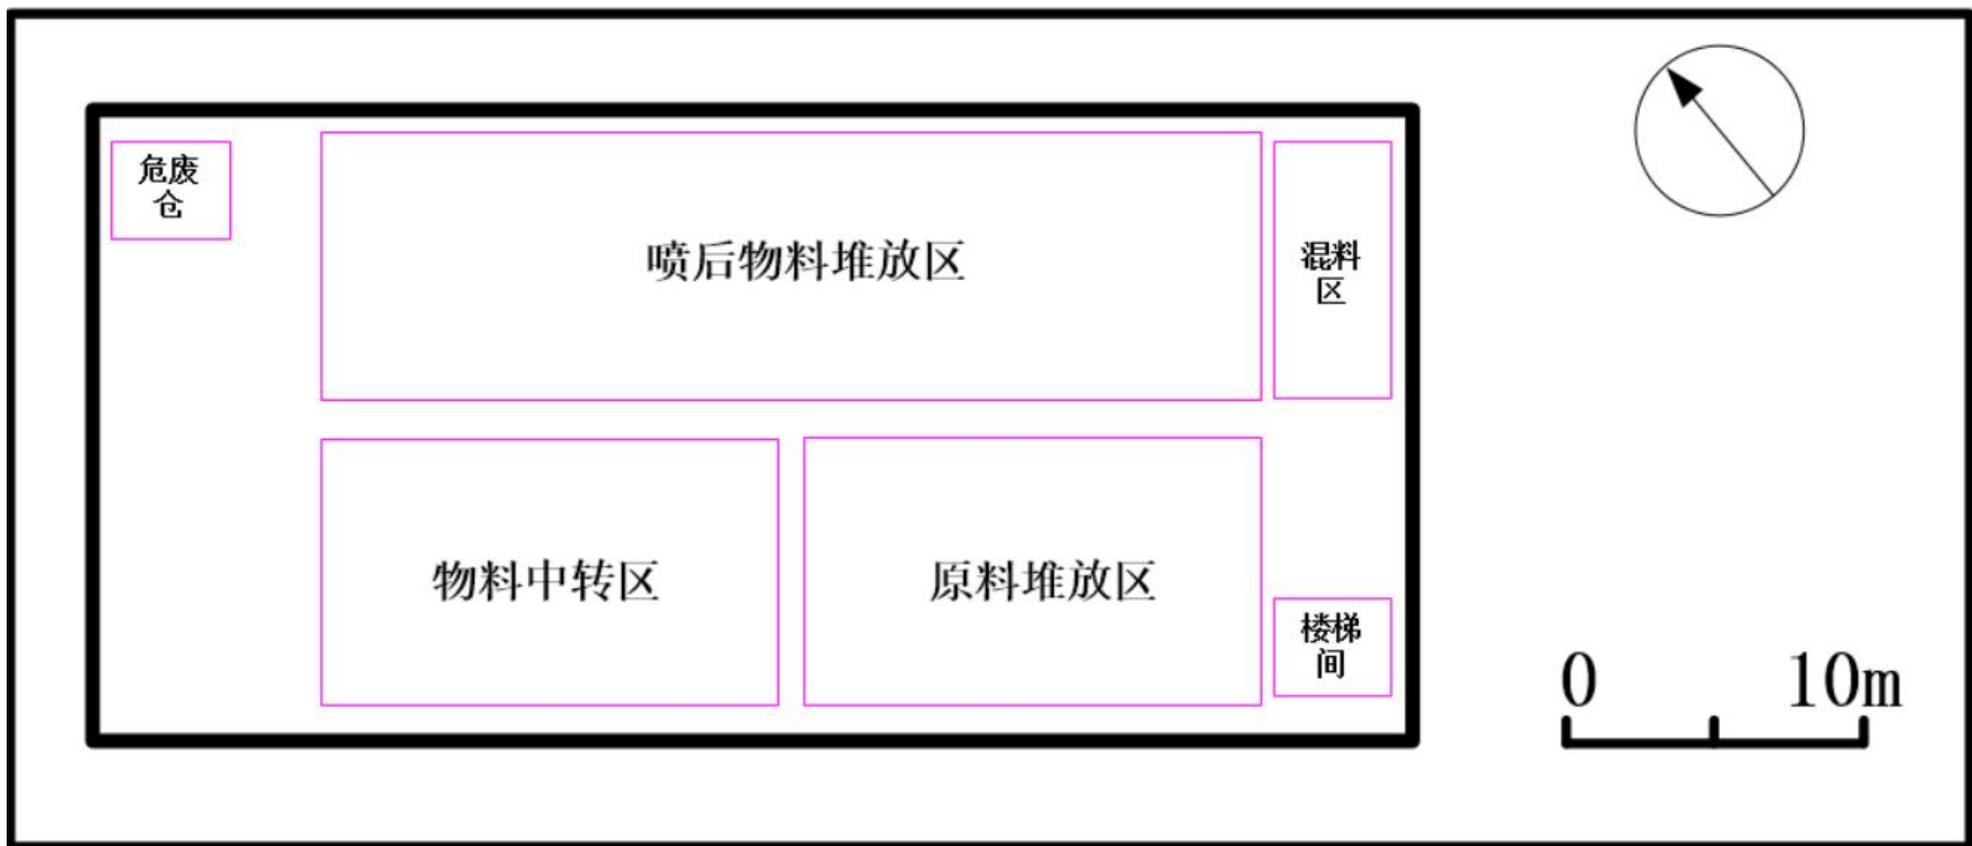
厂房A一楼平面布置图（二楼为预留发展区域）
